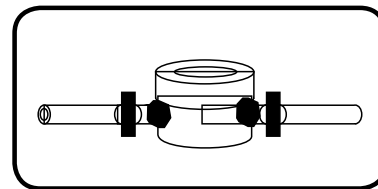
В месте установки элементов арматуры на трубопроводе
